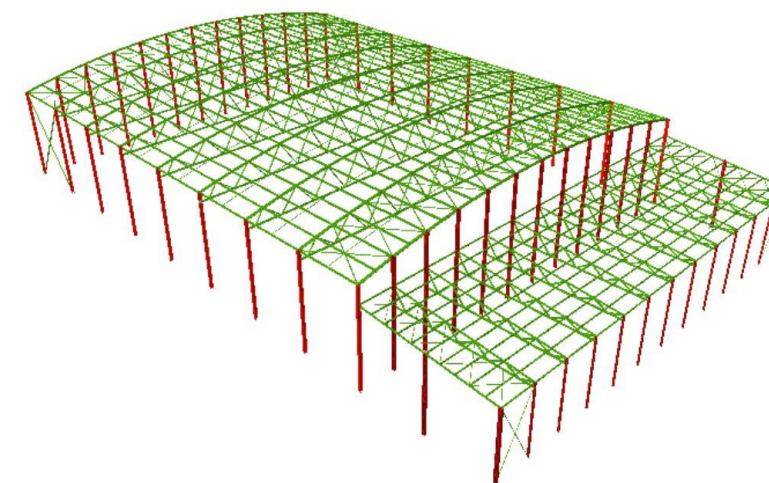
Esqueleto metálico de la estructura completo. Fuente: Propia.
